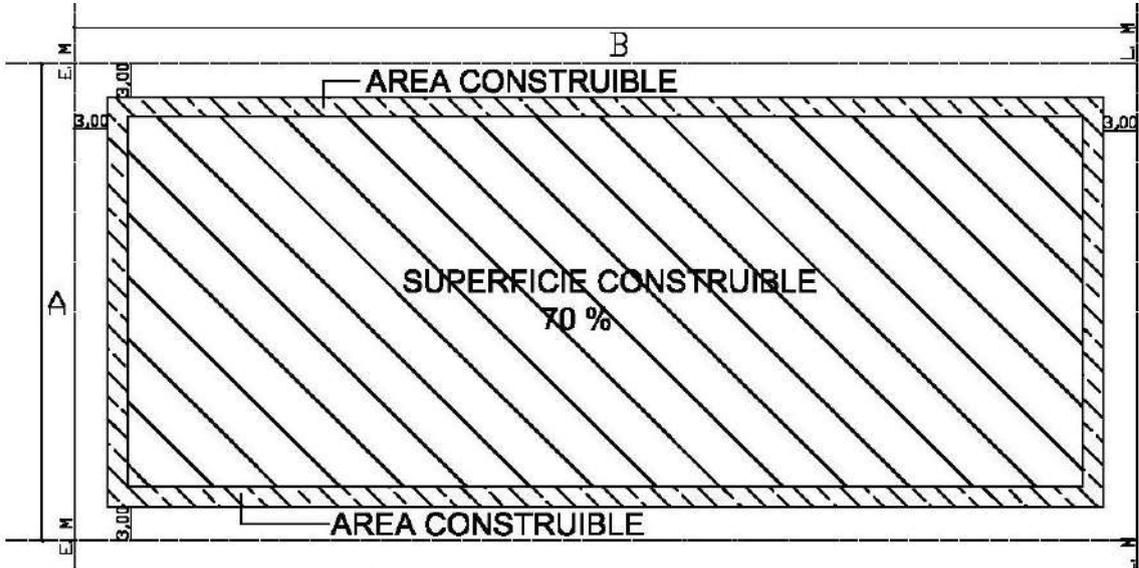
Lote tipo, con Área posible de construcción y superficie construible.
